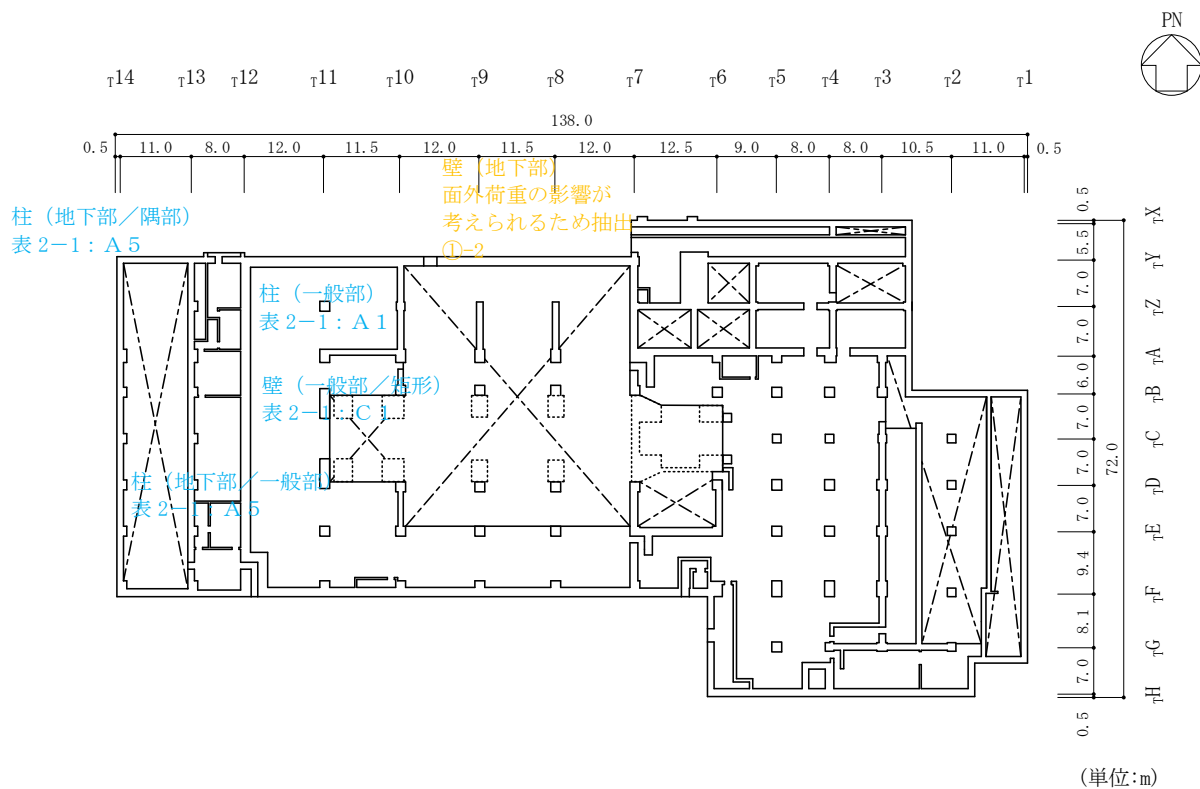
(2) タービン建物の概略平面図 (EL 5.5m)
